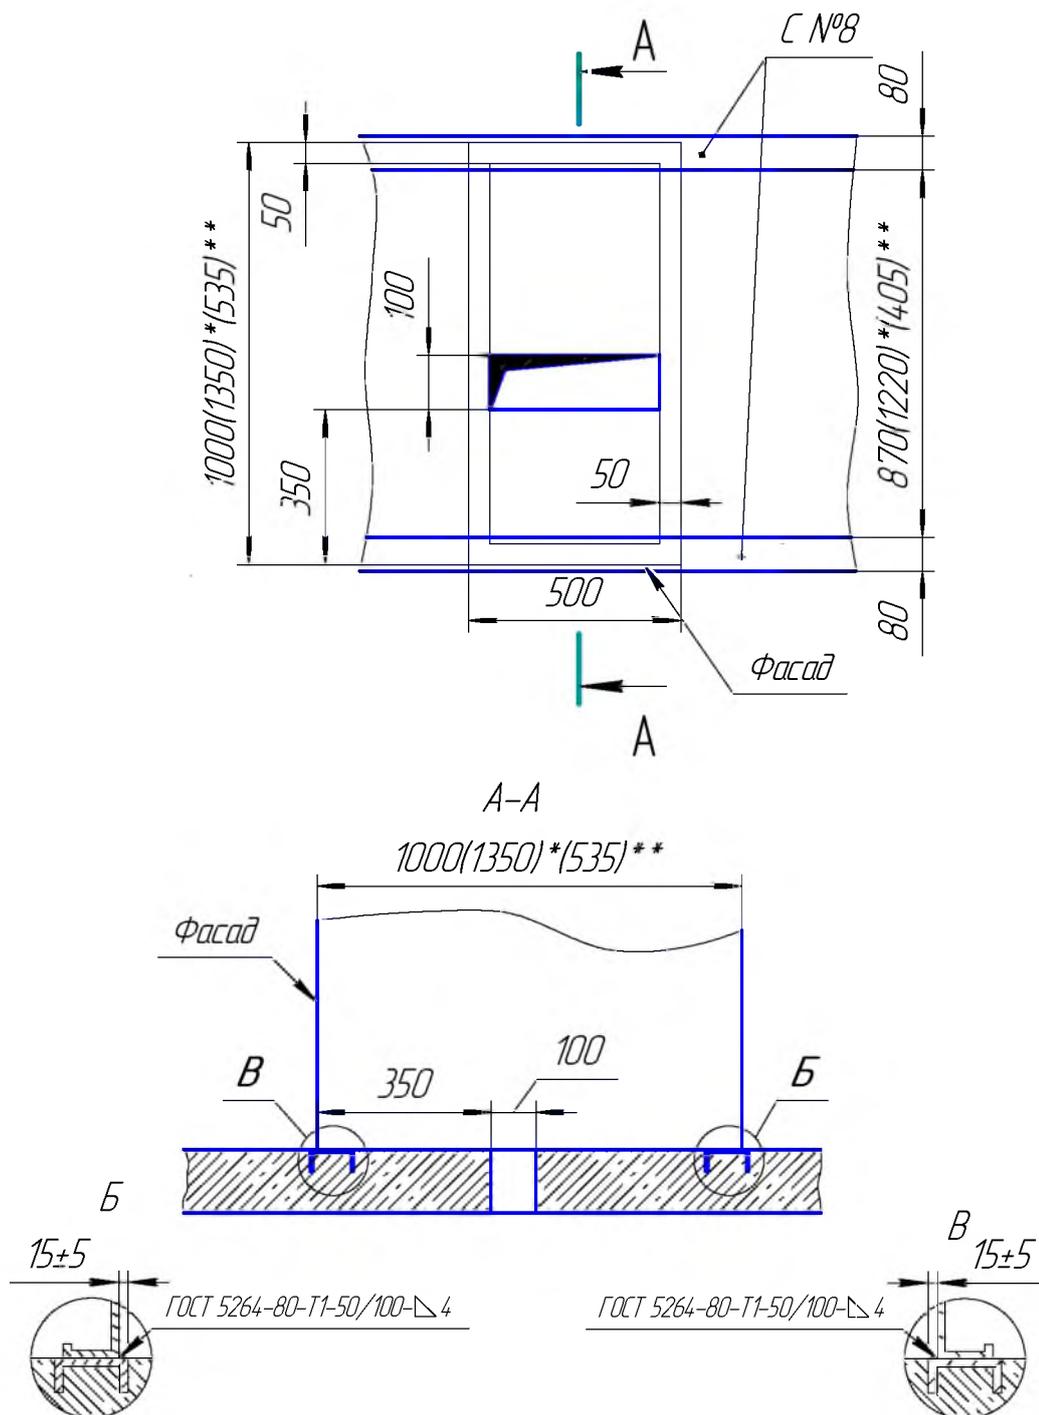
Установка шкафов РУНН на фундамент и ввод кабелей (*- для КТП 1600-3150 кВА)
